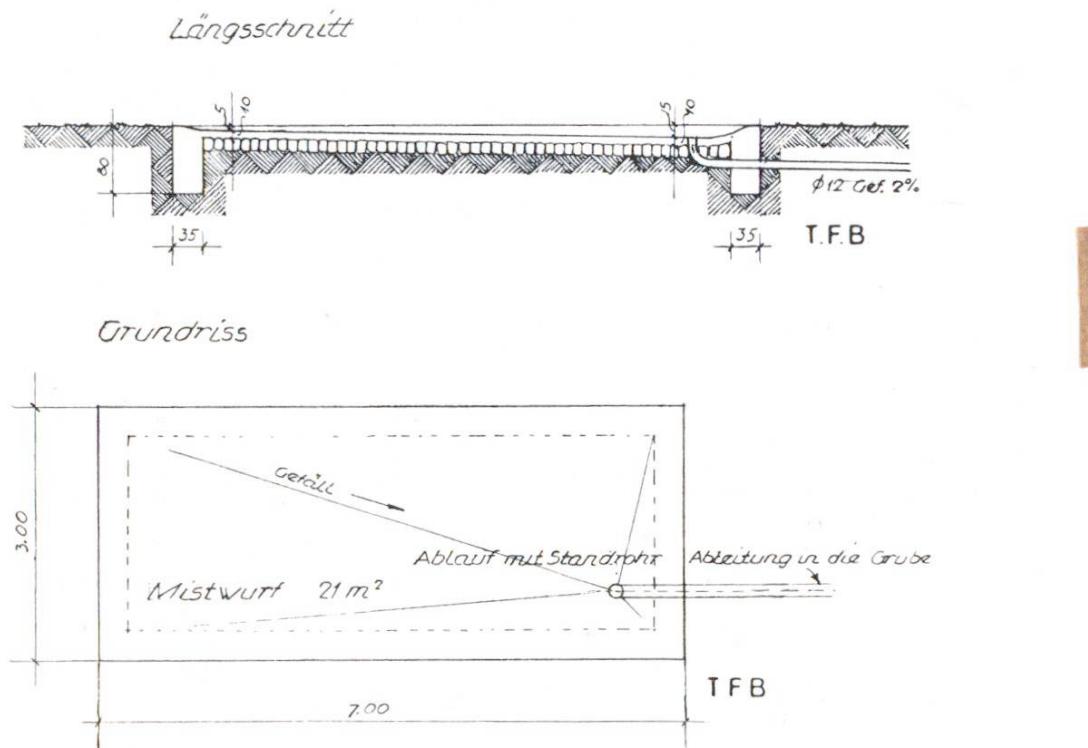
und 6 Mistwurf von 21 m<sup>2</sup> Fläche, Längsschnitt und Grundriss
